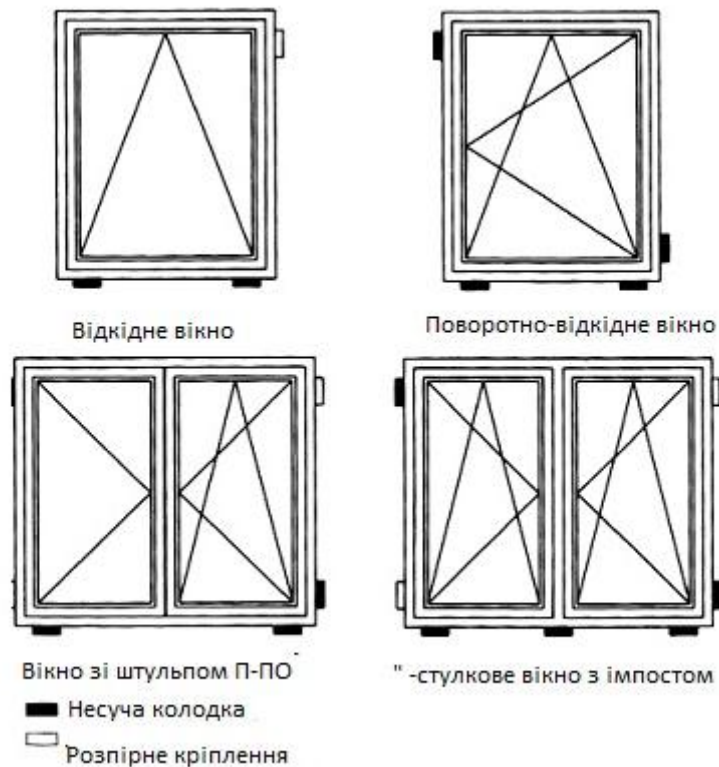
Схеми розташування опірних (несучих) та розпірних колодок-підкладок при улаштуванні вікон та дверей.
